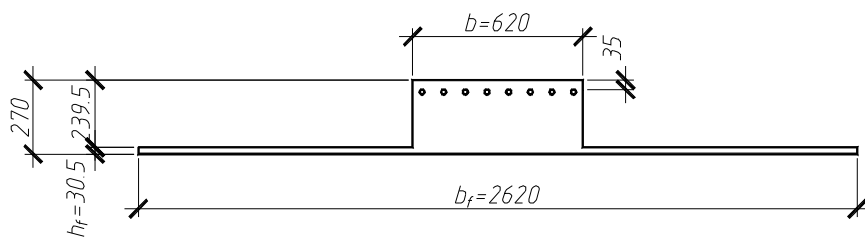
К подбору продольной арматуры ригеля в опорном сечении
